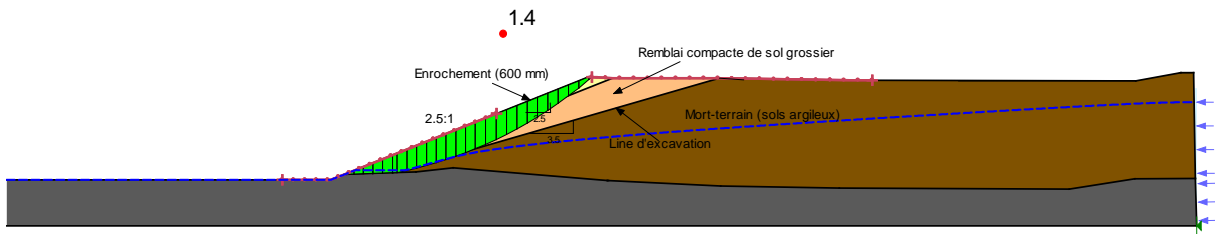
Stabilité pseudostatique, pente d'excavation 3,5H:1V et pente après le remblayage 2,5H:1V, excavation dans des sols argileux
